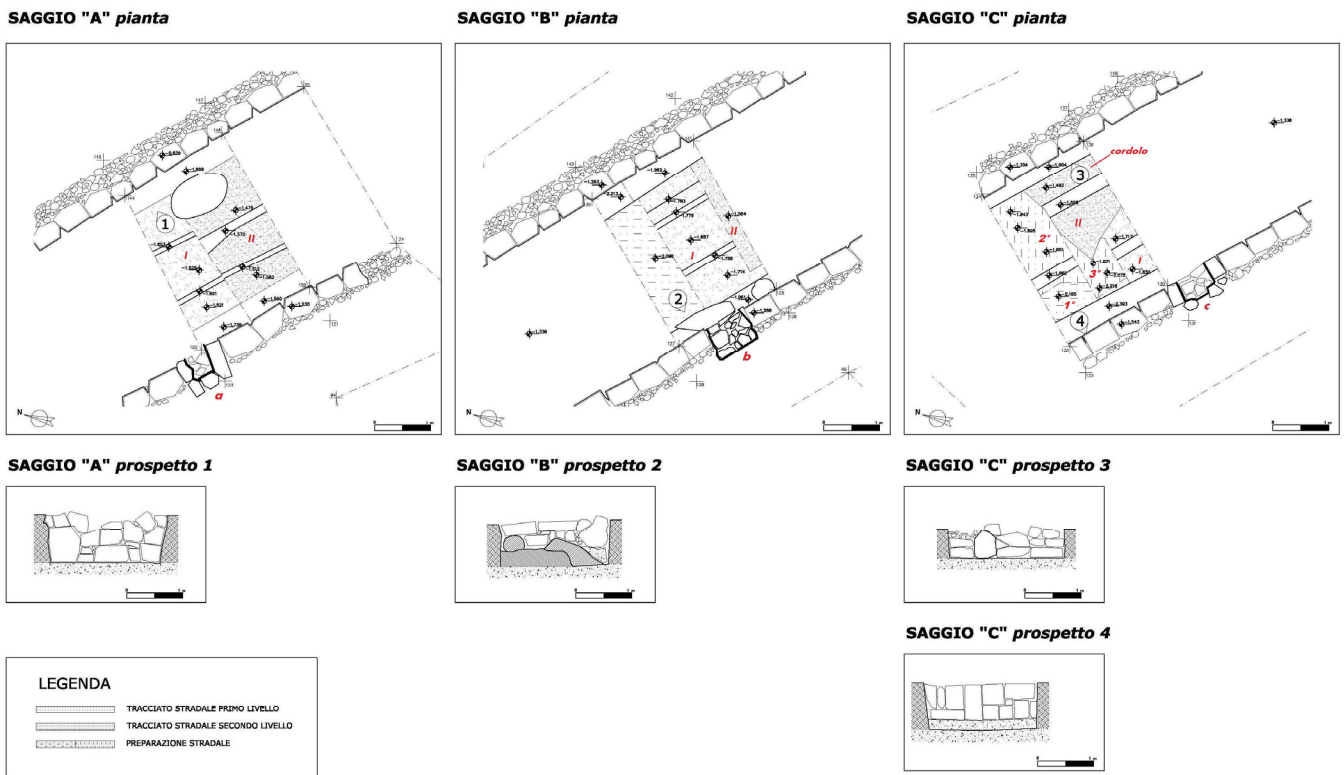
Planimetrie e prospetti dei saggi A-C nel tratto di strada (Studio di Architettura Livio Capparella).
